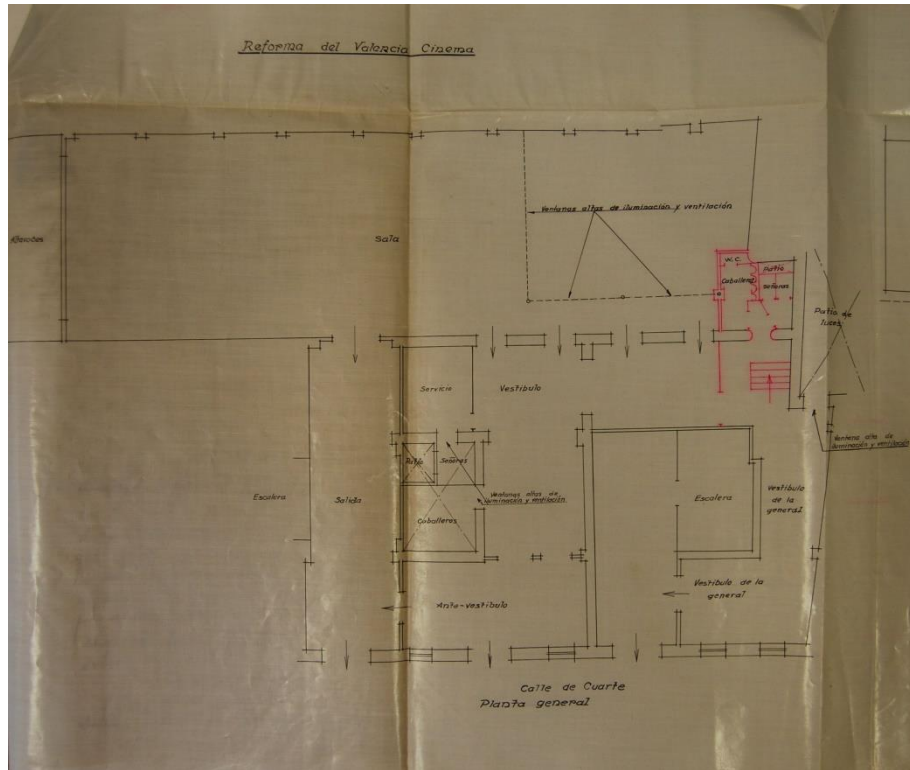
Planta baja del proyecto de reforma del Valencia Cinema
